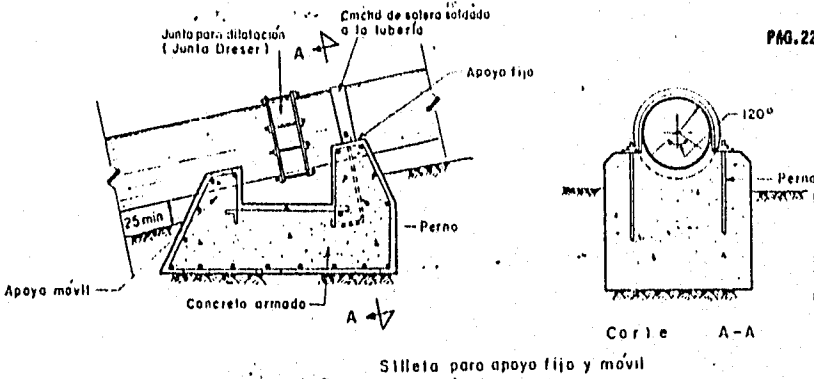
Silletas de concreto para sujeción de tubería.
